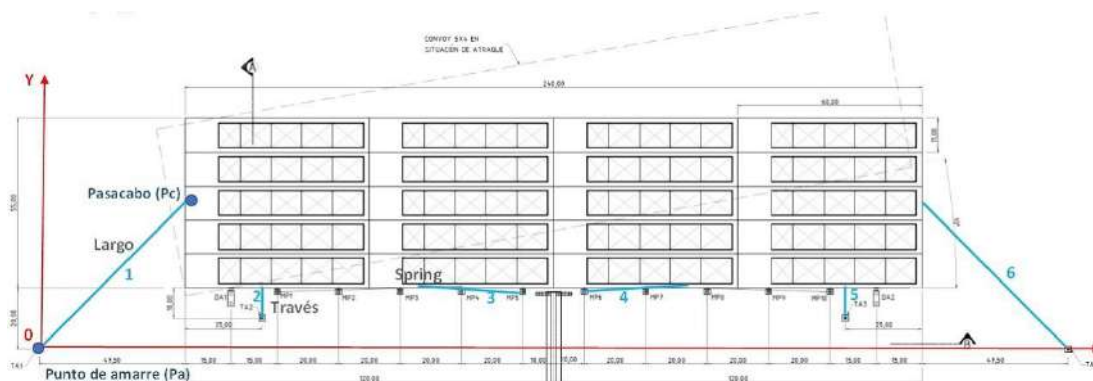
Disposición sugerida de ejes en el plano horizontal.
